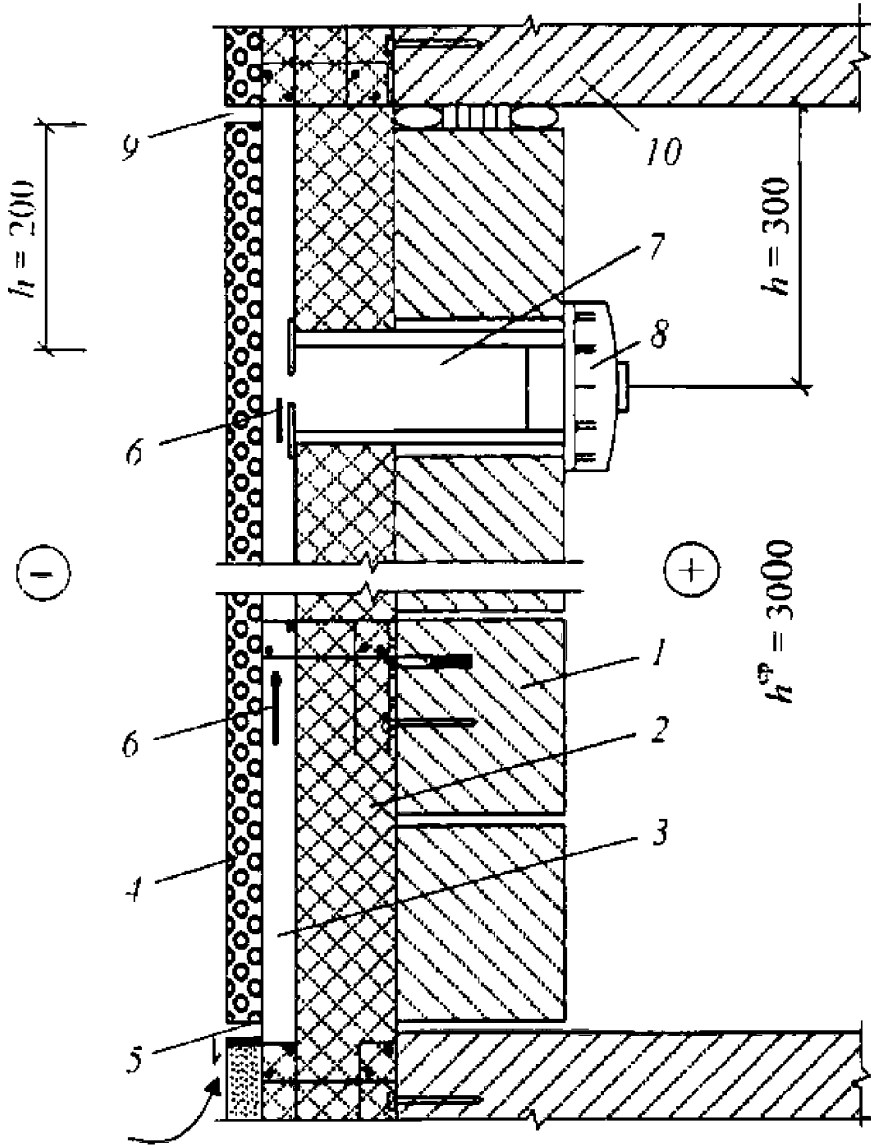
Принципиальная конструкция эффективной наружной стены с организованным воздухообменом:
